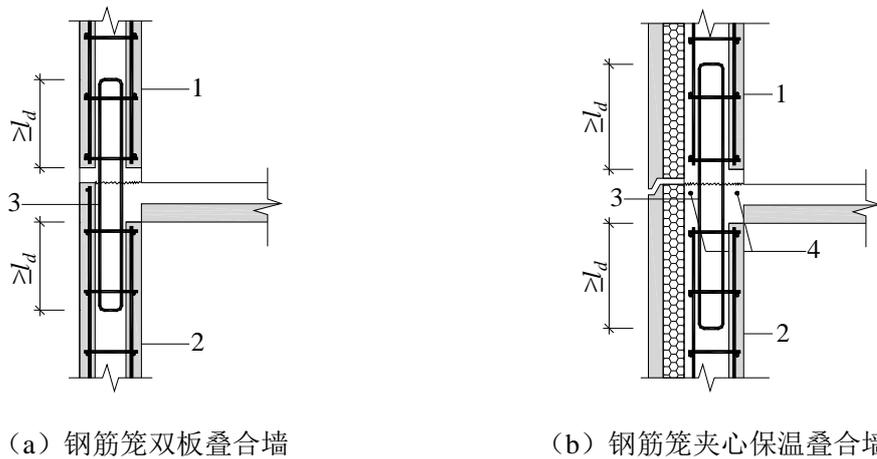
钢筋笼叠合墙水平接缝处竖向钢筋连接构造示意
